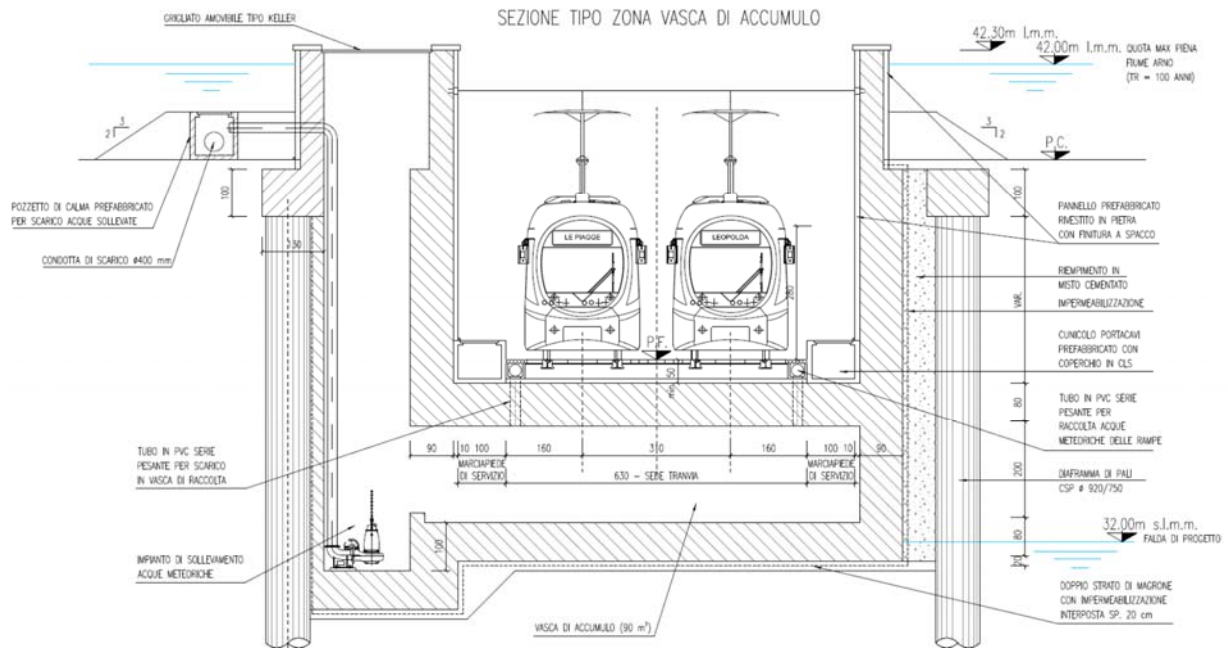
Sezione in corrispondenza della vasca di accumulo e impianto di sollevamento
